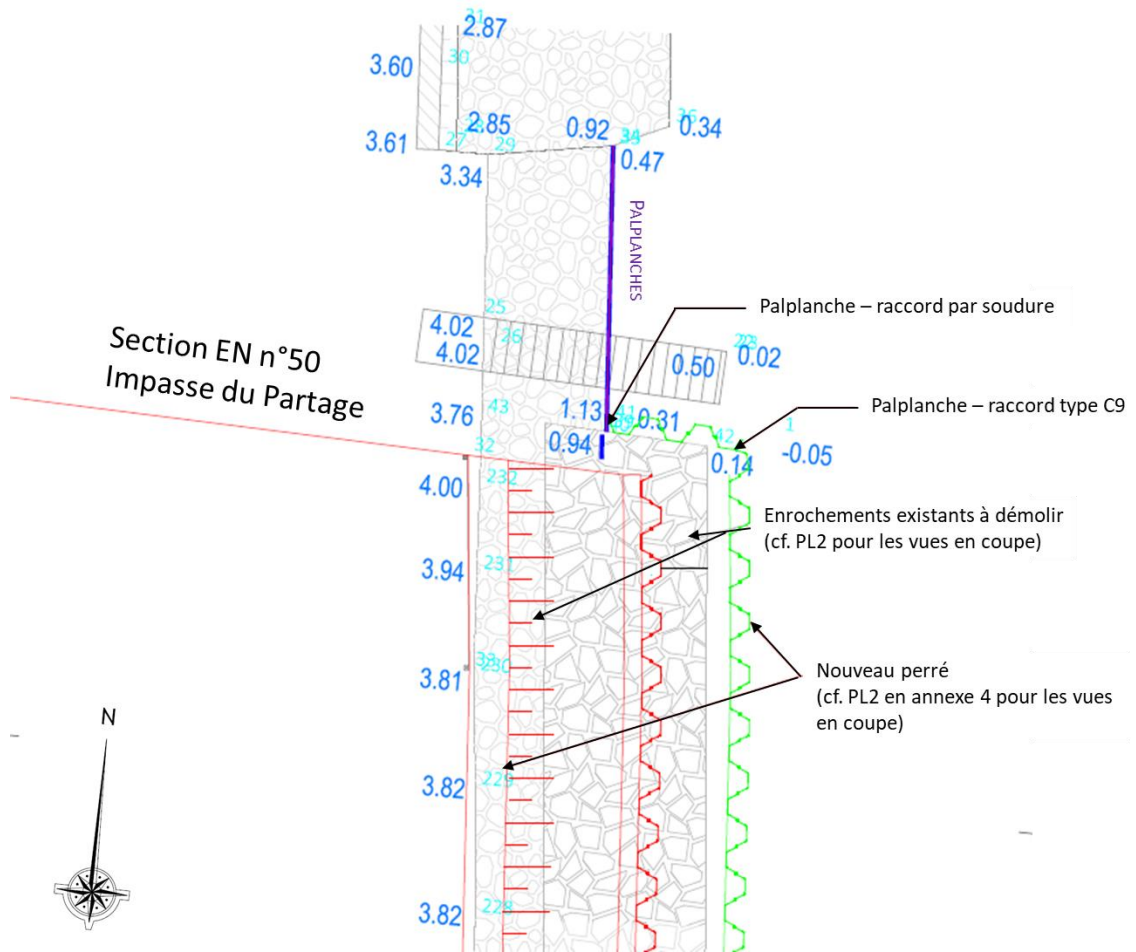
Plan du raccordement latéral de l'ouvrage dans sa partie Nord (cf. annexe 4 : plans du projet)
